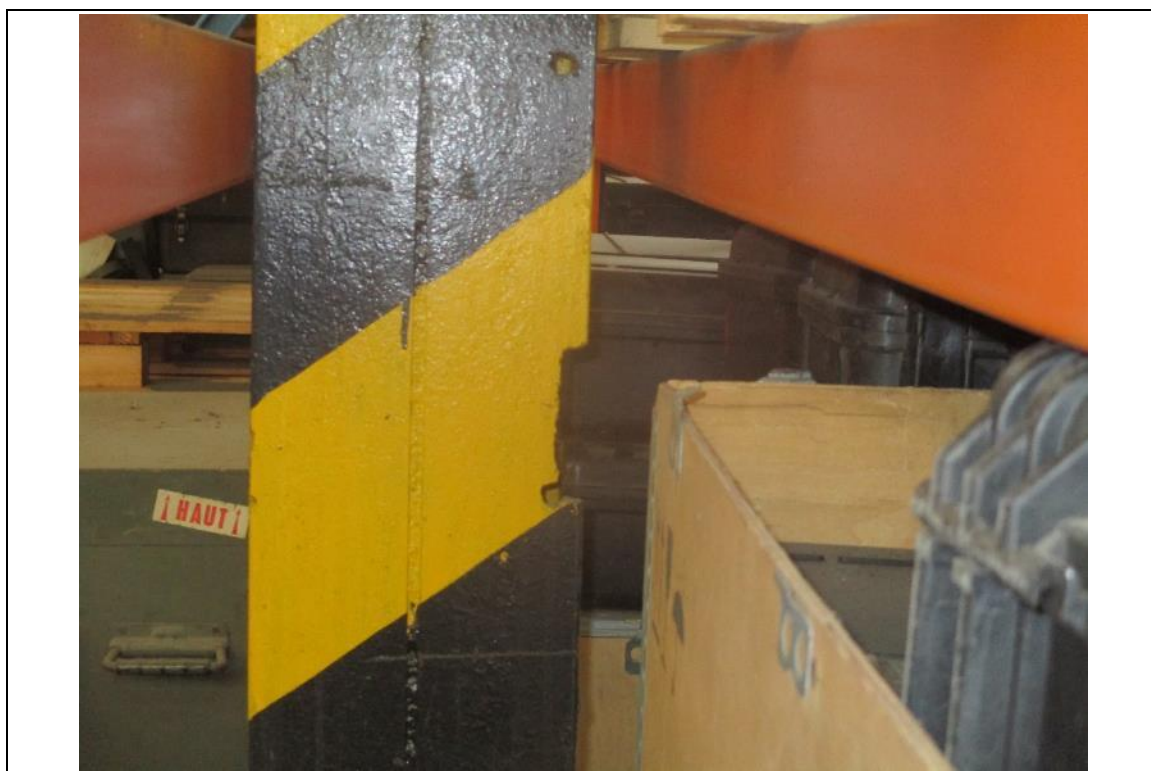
Traces de découpe - Local 010, B5, rayonnage 234
